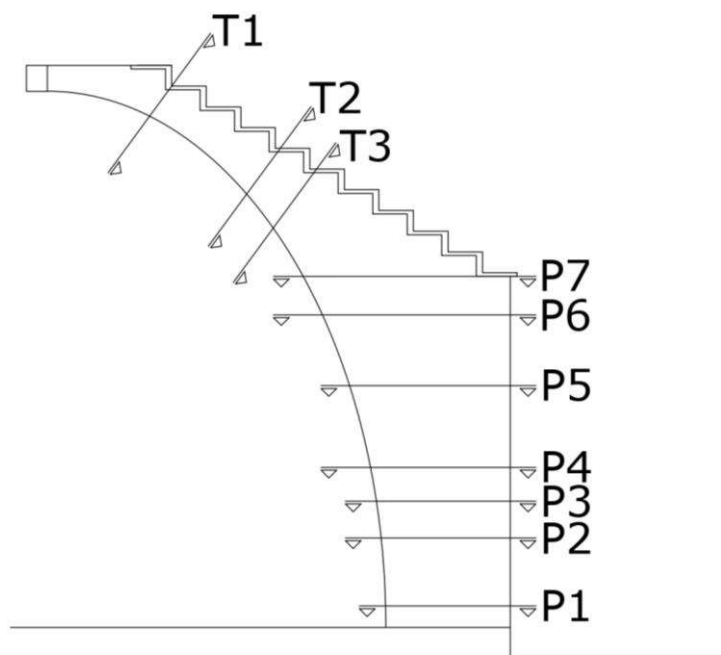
Telaio 6 con indicazione delle sezioni oggetto di verifica
